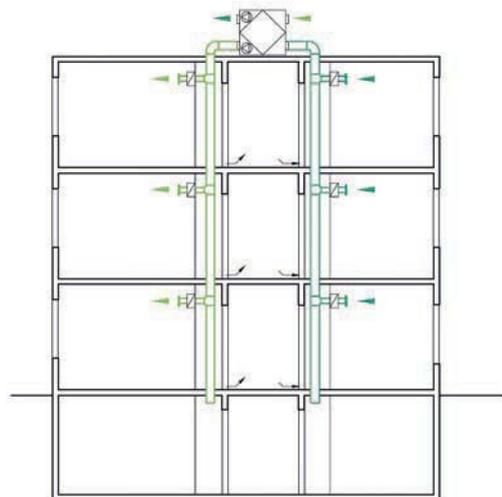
Schema einer zentralen Anlage mit Lüftungszentralgerät im Dachgeschoss (Quelle: [Detail 2016])
